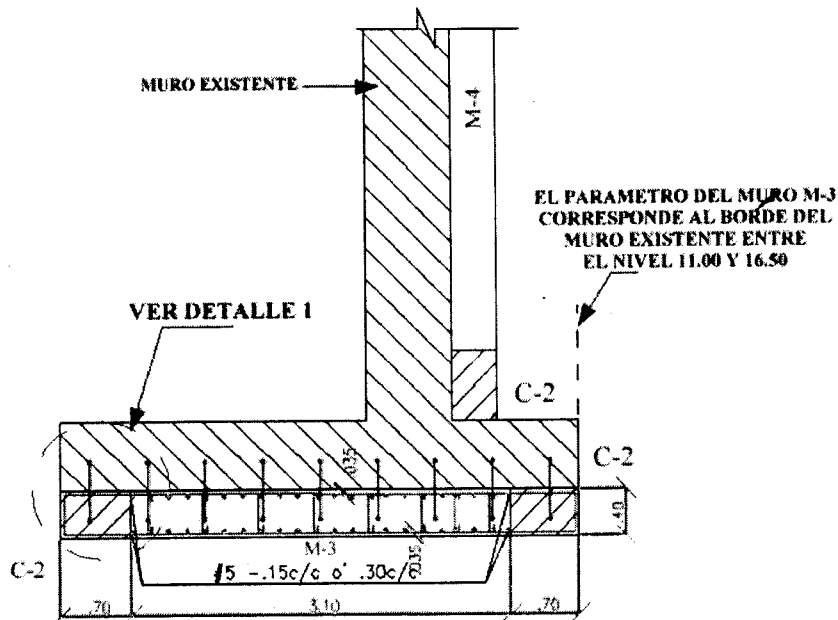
Detalle de plano de anclajes de uno de los muros adosados
